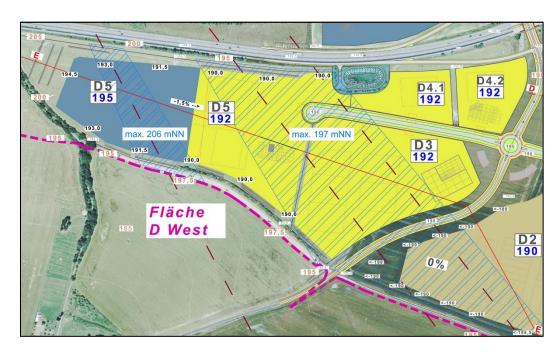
geplante Profilierung Fläche D West (Original im Anhang)
